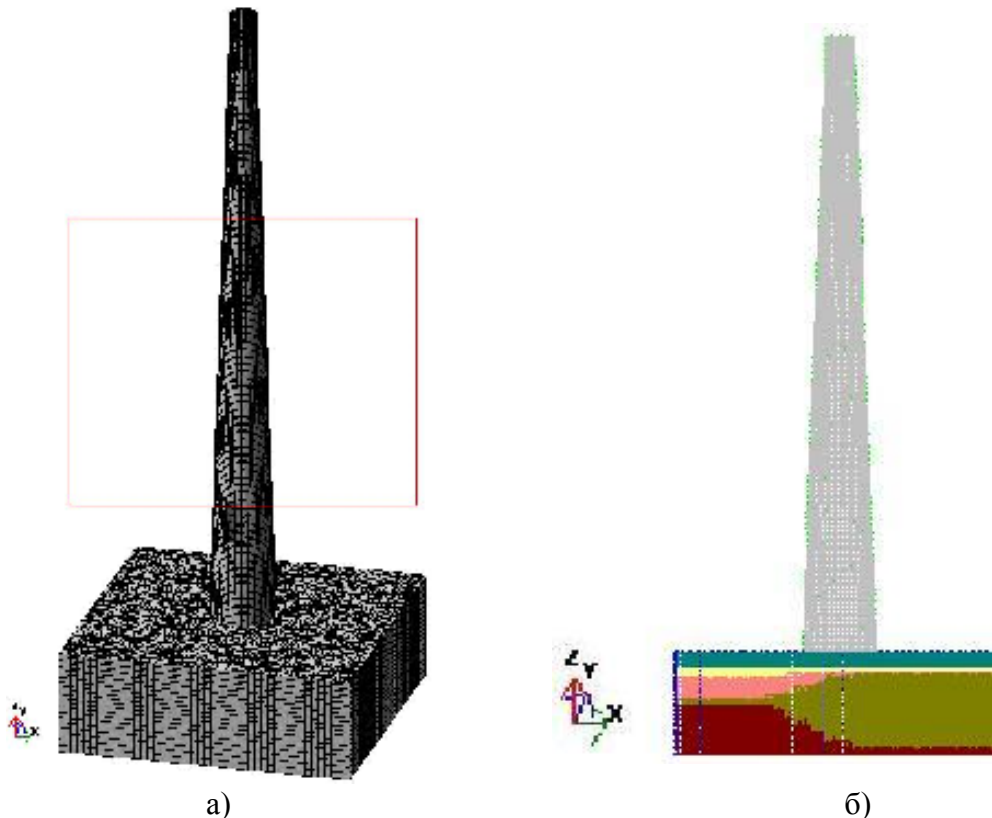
Расчетная модель вентиляционной трубы и трехмерного грунтового массива основания: а – аксонометрическая схема модели ствола вентиляционной трубы и трехмерного грунтового массива; б – конечно-элементная модель вентиляционной трубы и трехмерного грунтового массива
